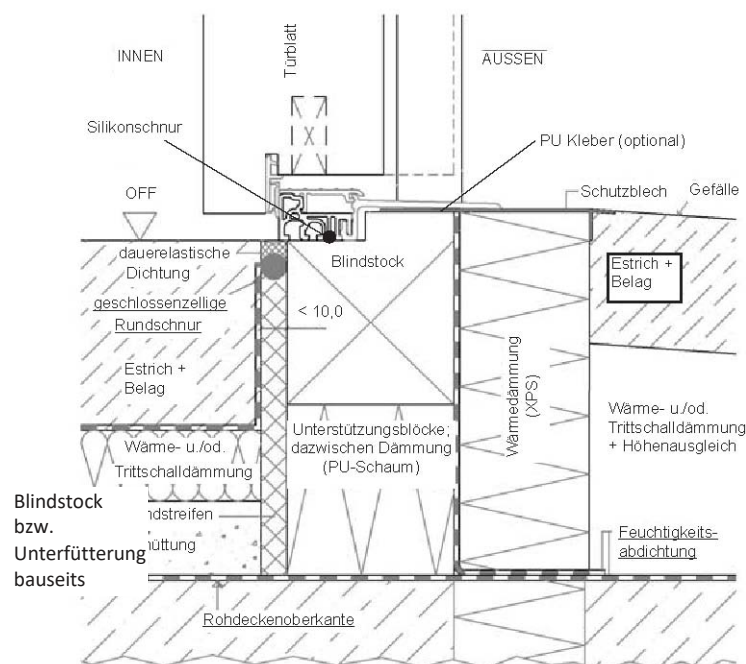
Bodenanschlusssdetail für Laubengang- u. Passivhaustürelement
